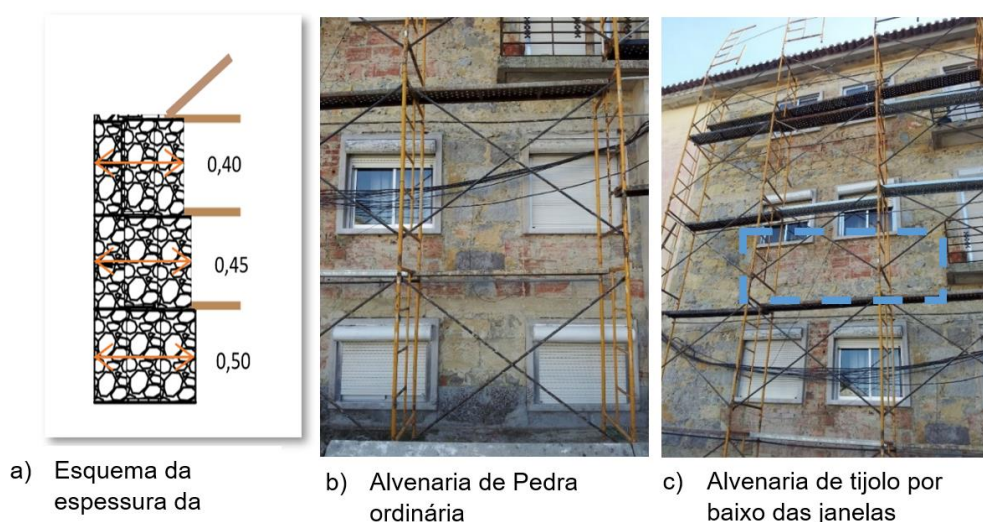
12 - Paredes de fachada do edifício em estudo, dimensões em m.
